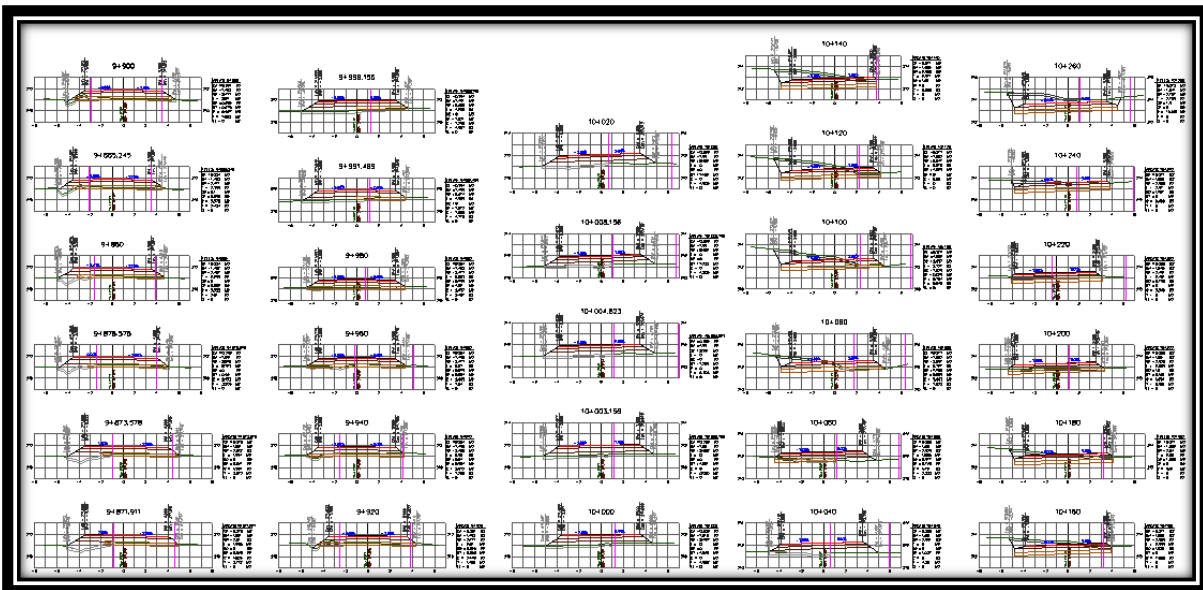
Secciones de construcción del km 9+871.911 al km 10+260.000.
